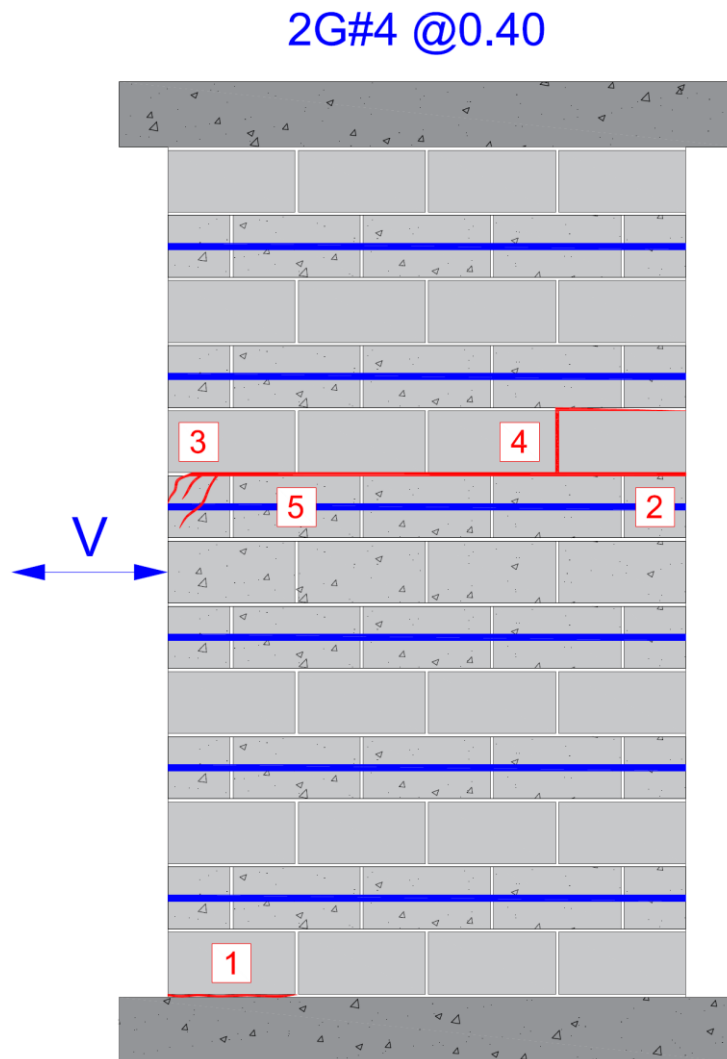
Fisuración y modo de falla del muro MC-2#4/40
